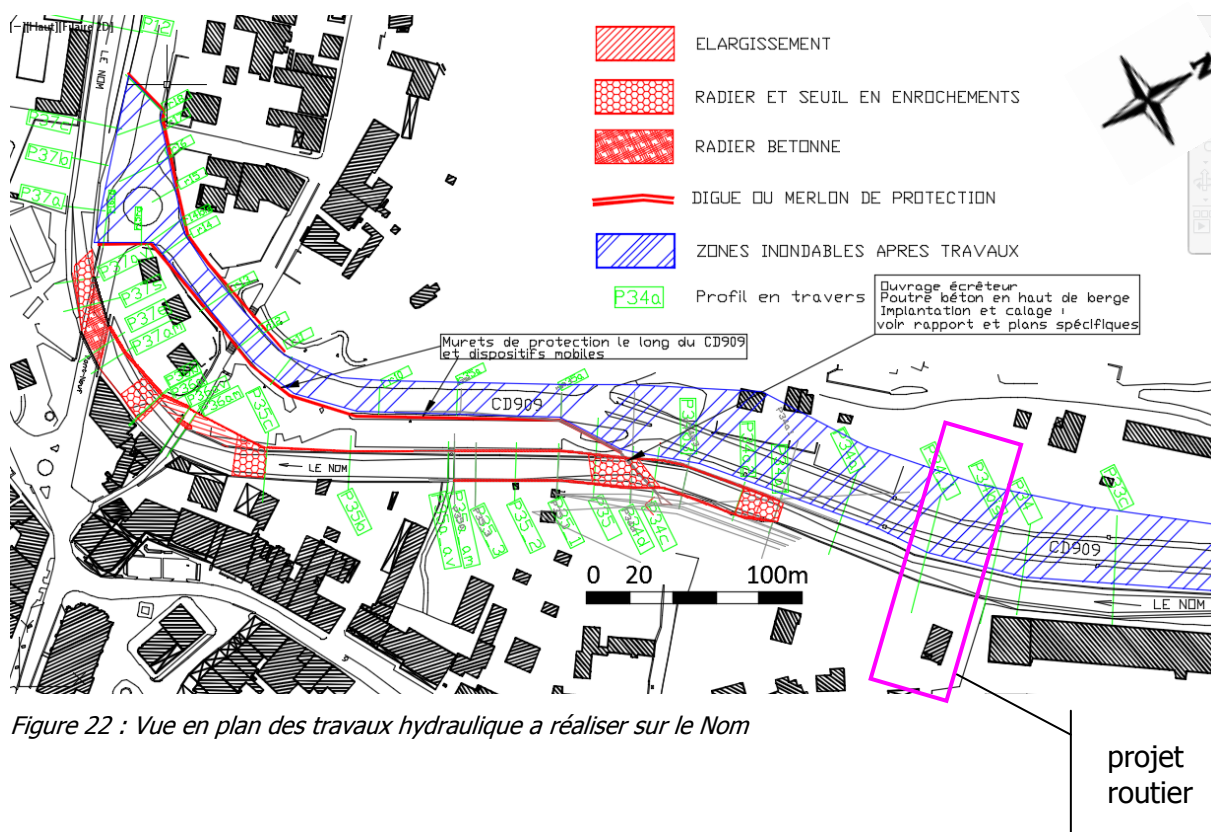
Vue en plan des travaux hydraulique a réaliser sur le Nom
